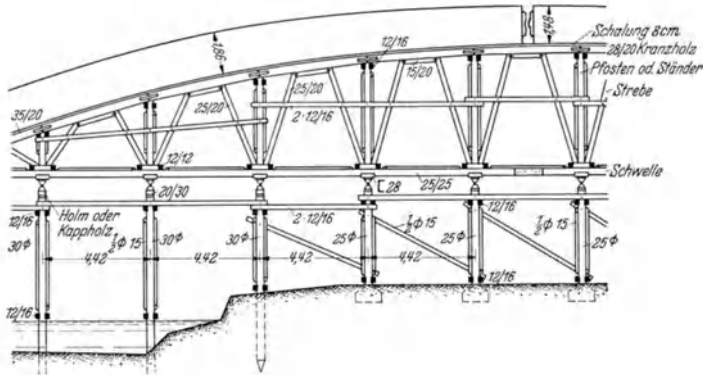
Lehrgerüst der Neckarbrücke Cannstatt.
